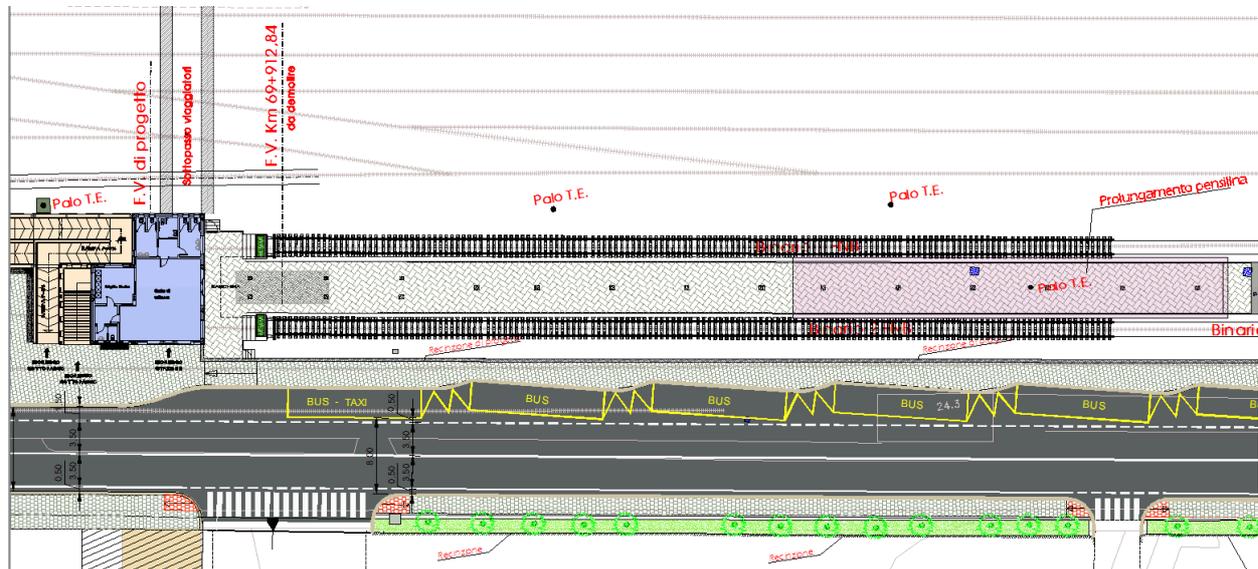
Stazione di Barletta Centrale: pianta livello banchina stato di progetto
